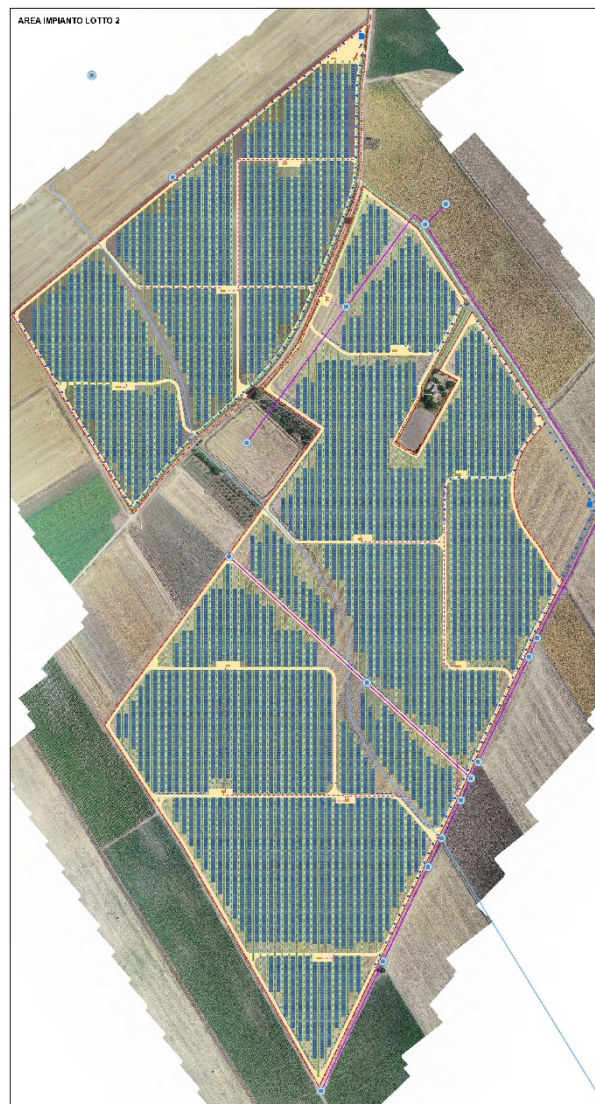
Estratto elaborato OLKV965_GRAF_M.1_rev_1 (Planimetria impianto olivicolo)
